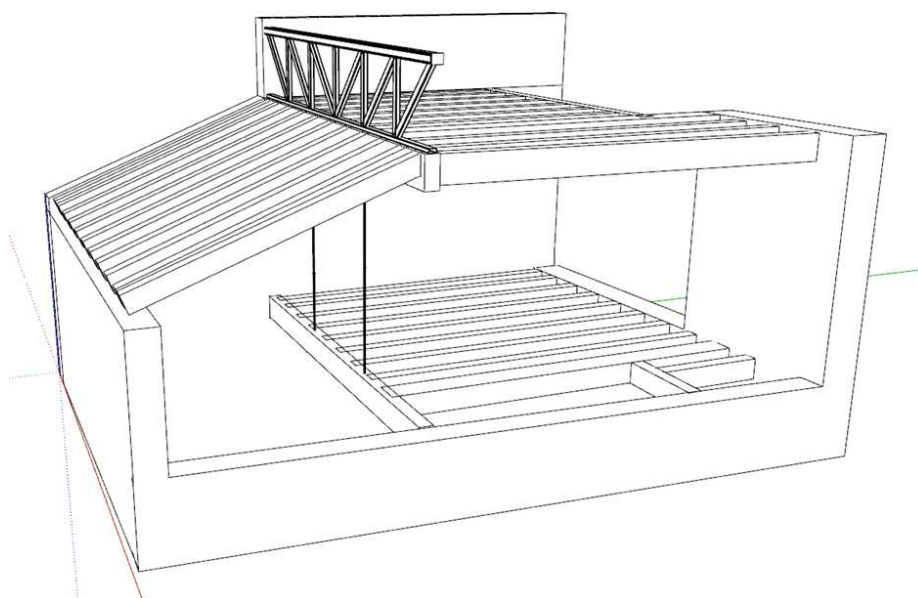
Esquema gráfico de estructura de planta de cubiertas entre muros 0M y 1M
